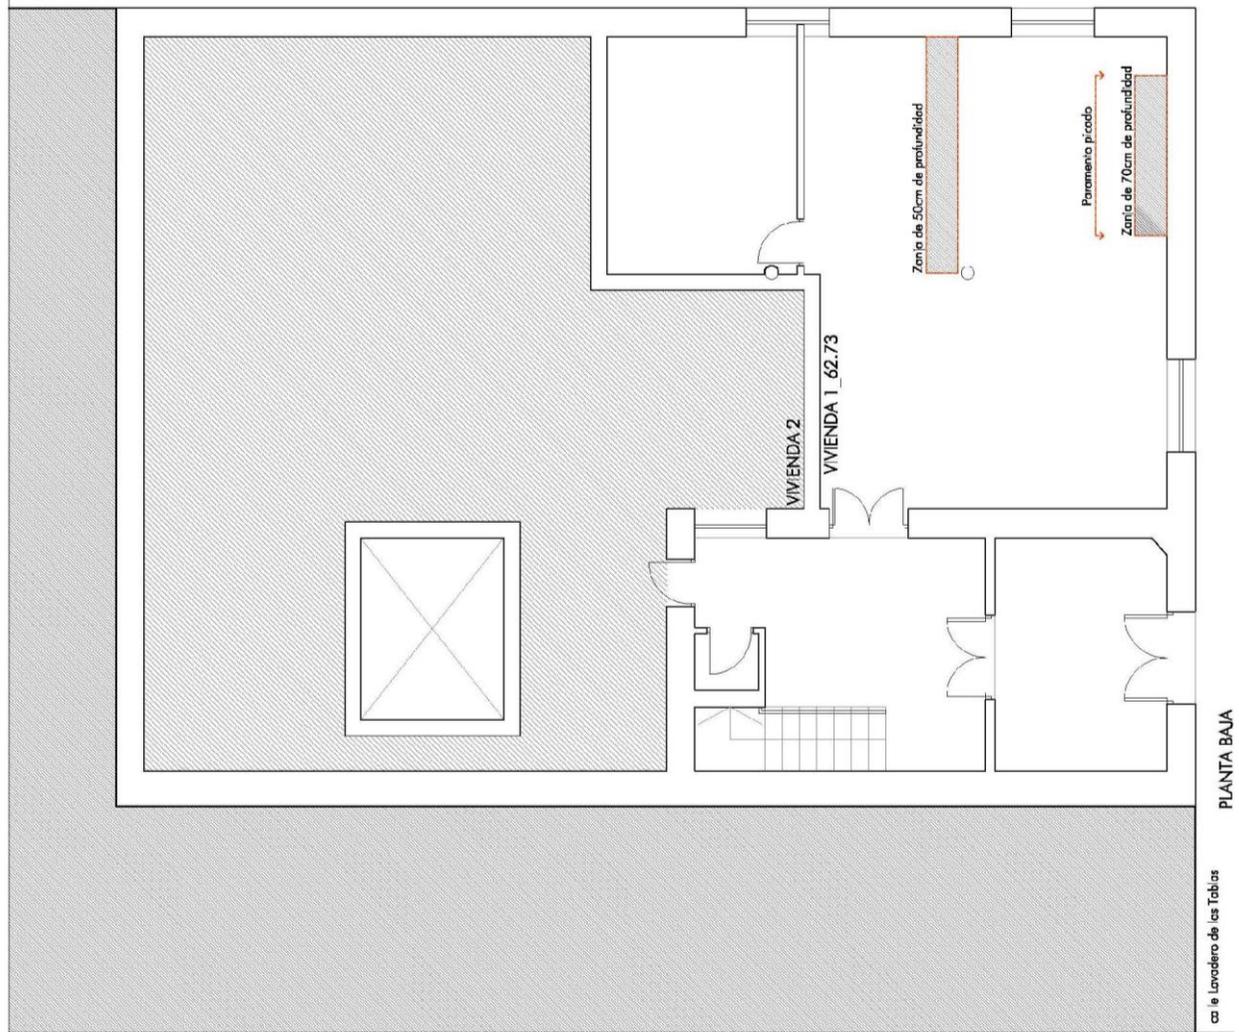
Ubicación de las zanjas efectuadas sin control en planta.
